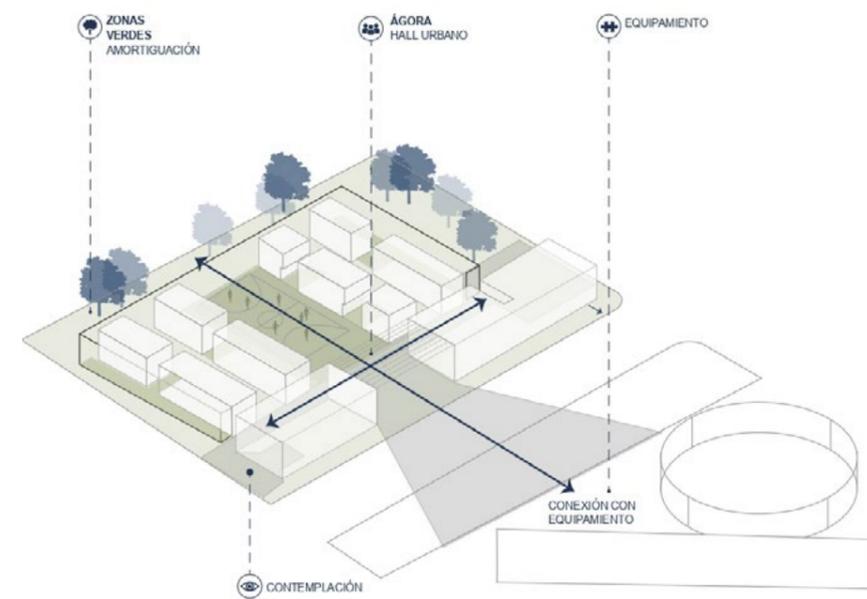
Conexión con el paisaje: Colegio Pradera El Volcán. Fuente: Elaboración propia, 2025.
